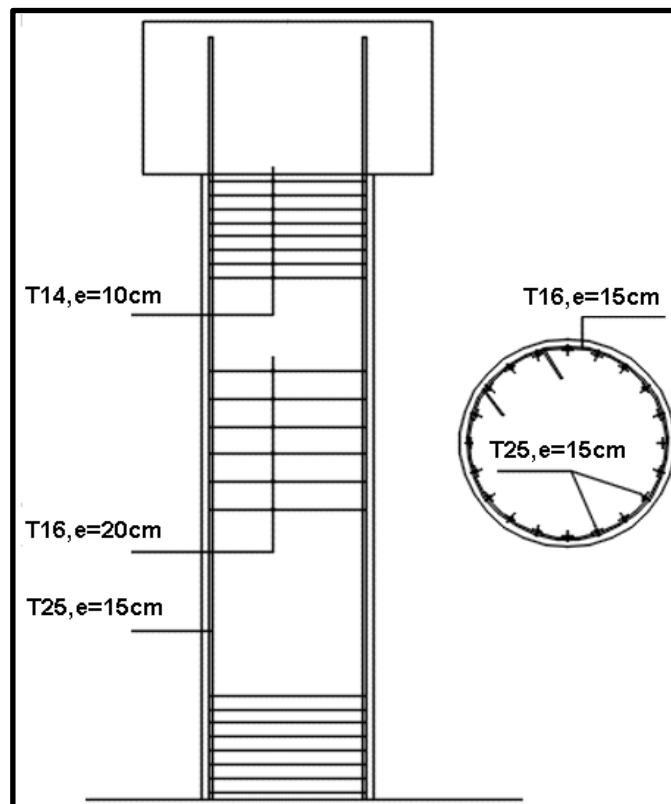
ferrailage des pieux (coupe 2)
